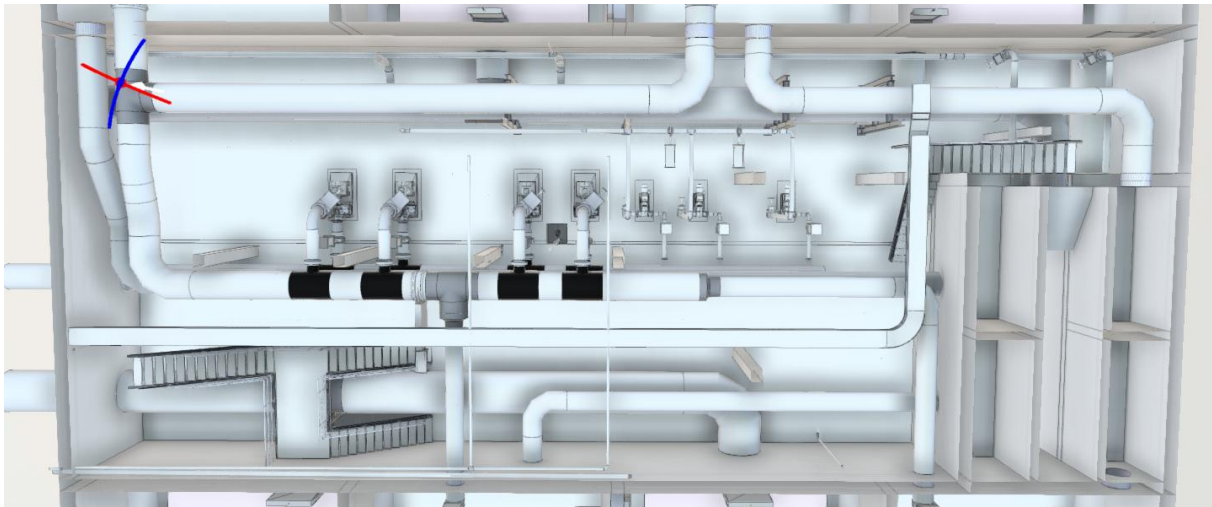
Grundriss KG Maschinenhaus Belegung
